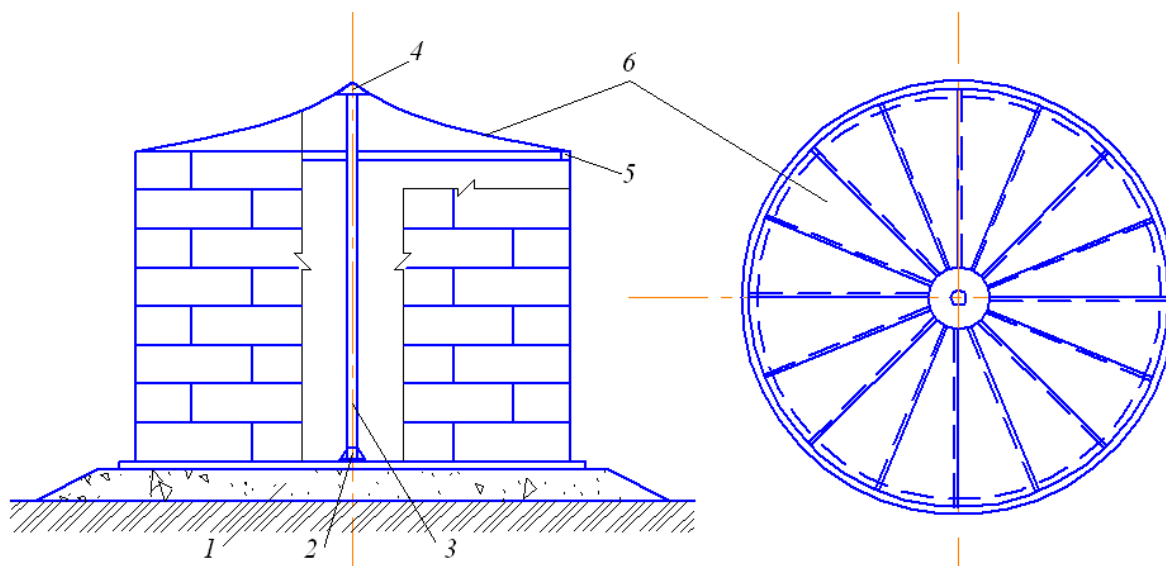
Конструкция вертикального резервуара с безмоментной крышей:
